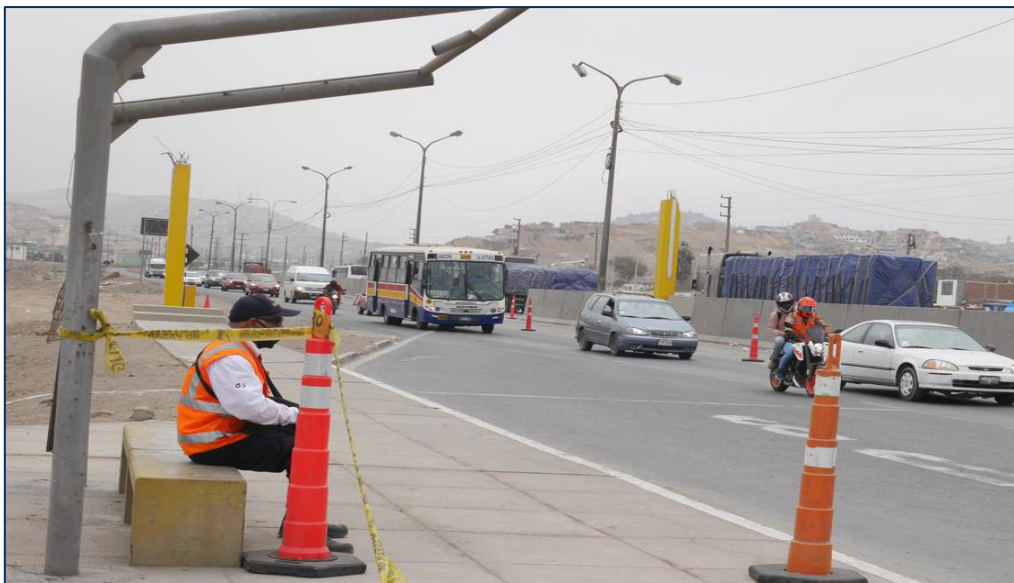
Situación actual del paradero Campamento (sur a norte).
